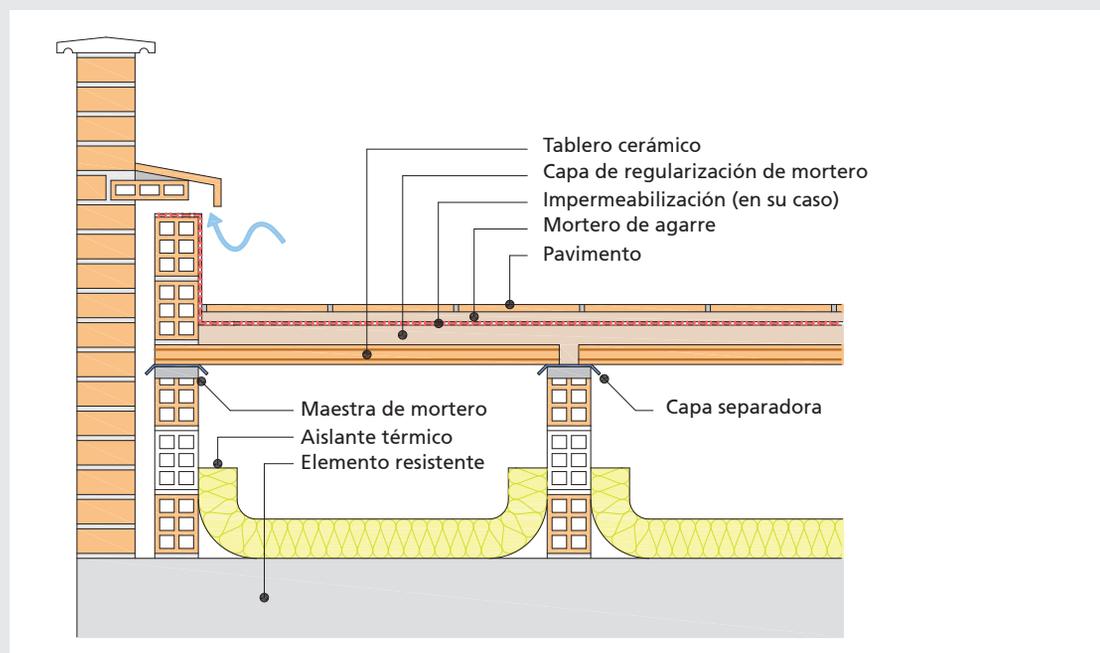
Cubierta plana de tablero cerámico sobre forjado
